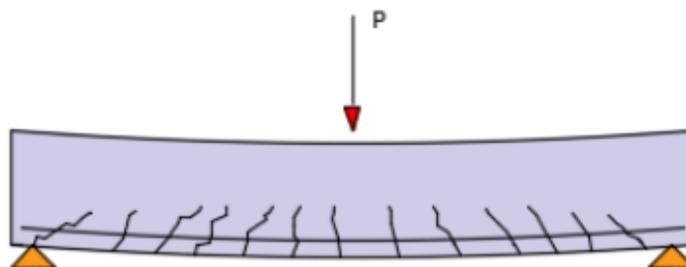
Fisuras en el concreto armado ante la acción de las cargas (P). Aguilar, J, 2015. Análisis y diseño de un edificio de 8 niveles empleando diferentes sistemas de piso: losas de concreto reforzado perimetralmente apoyadas y losas planas de concreto postensado. pág. 19.
